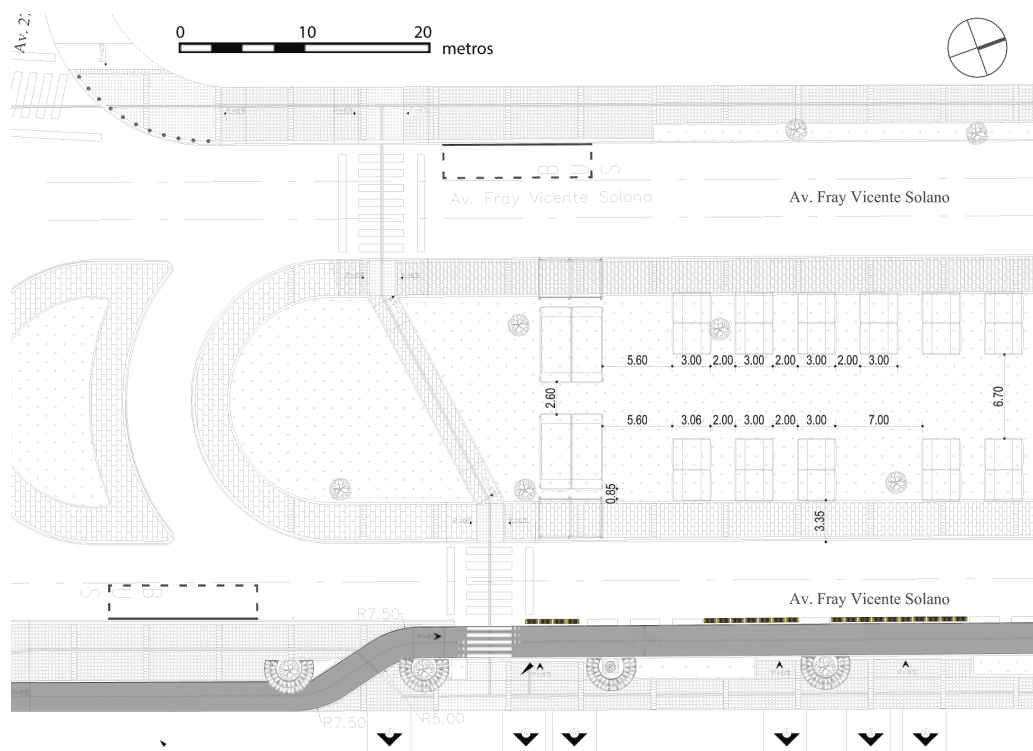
Emplazamiento del Tramo 1A. Elaboración: Autores.
